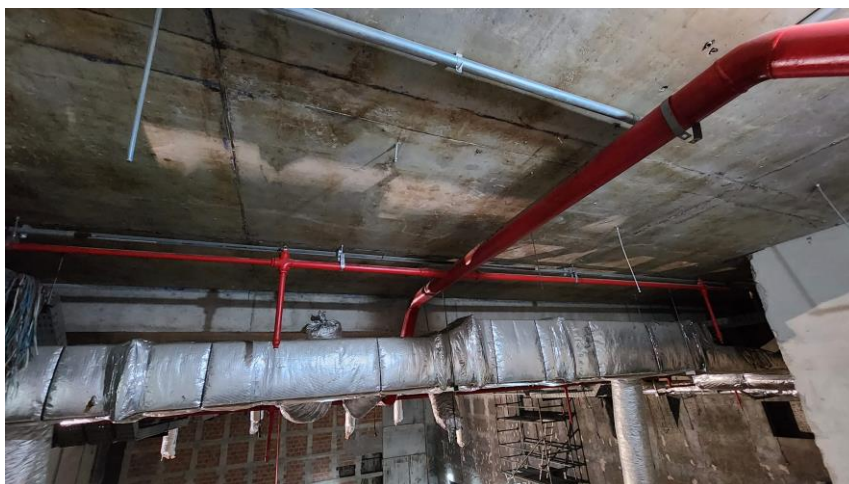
Demonstração da Patologia da Tubulação de aço galvanizado de 25 mm – 2º Pavimento
